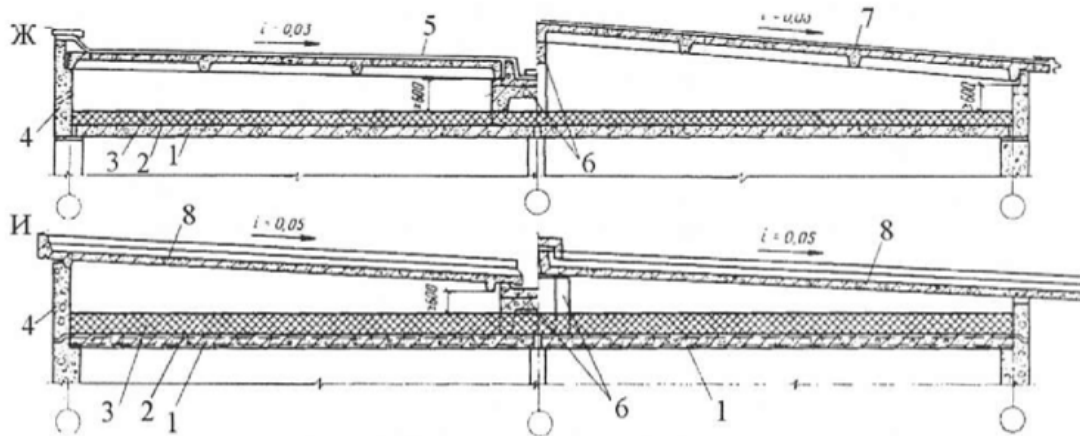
Схемы вентилируемых крыш с рулонной (ж) и безрулонной (и) кровлей (варианты с организованным и неорганизованным водостоками):
